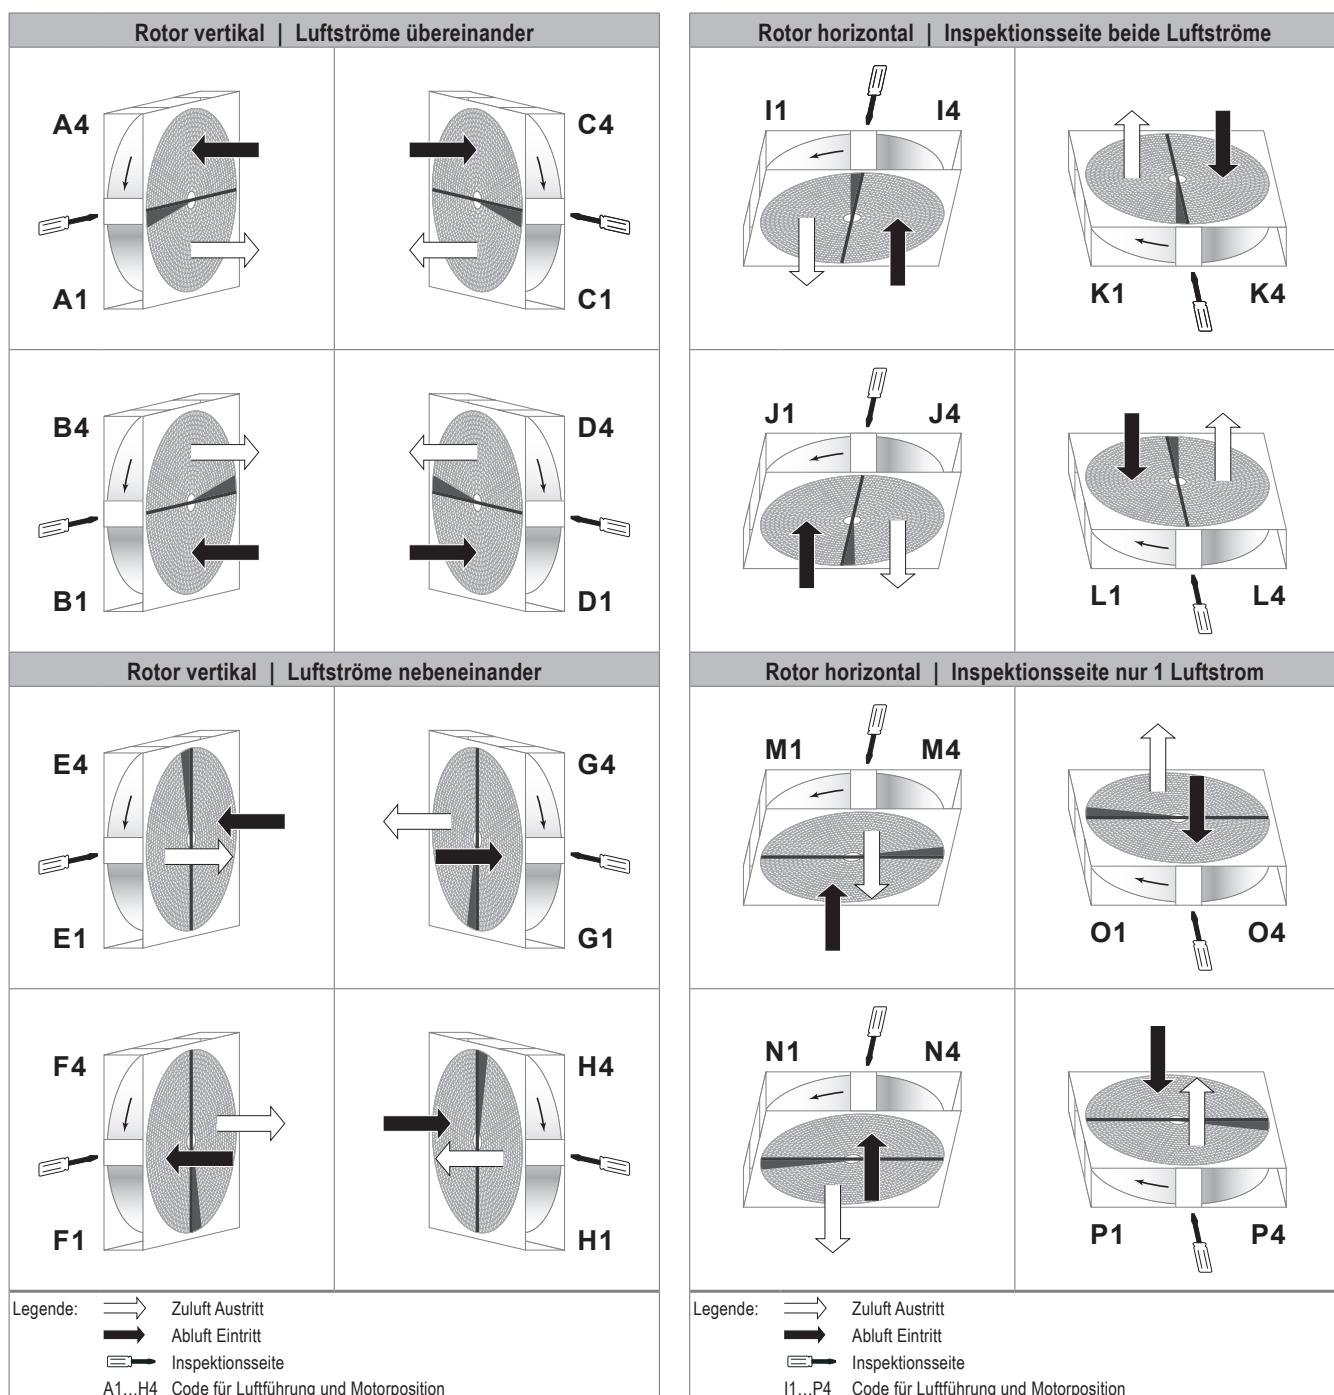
Luftführung und Motorposition für vertikale Ausrichtung
